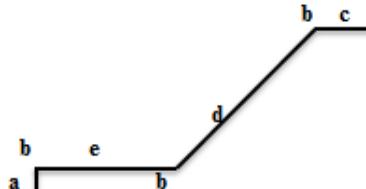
25 Detail Tulangan Memanjang Atas Tangga B
